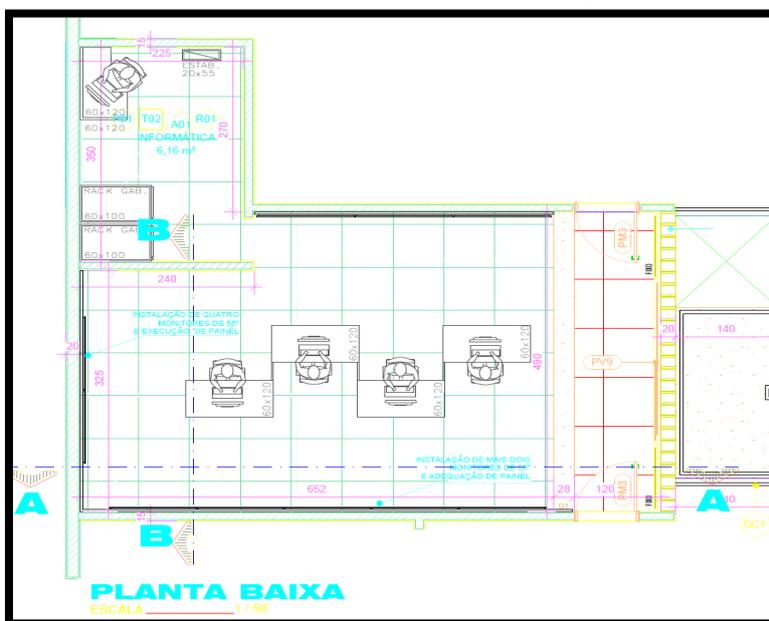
Planta Baixa da sala do Centro de Controle Operacional
